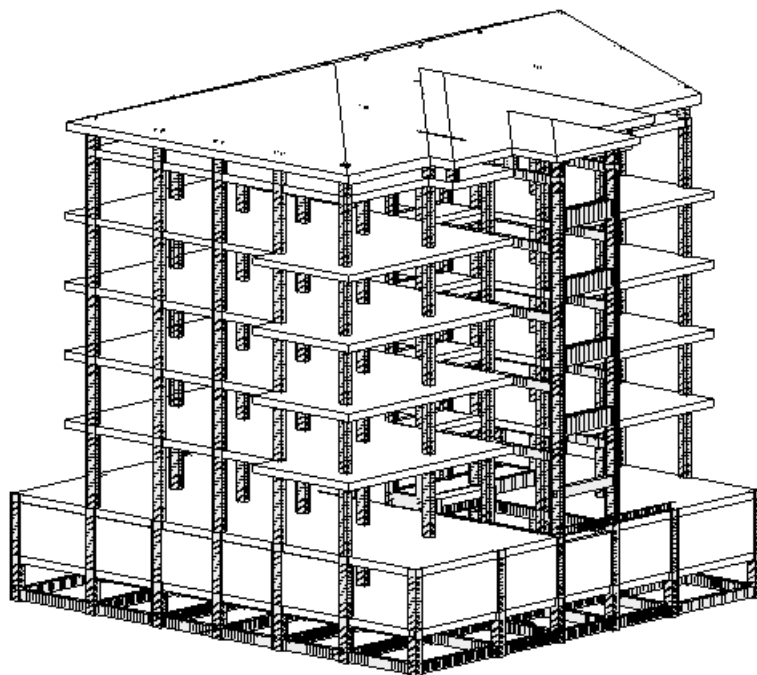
Modelo estrutural com as armaduras devidamente posicionadas.
